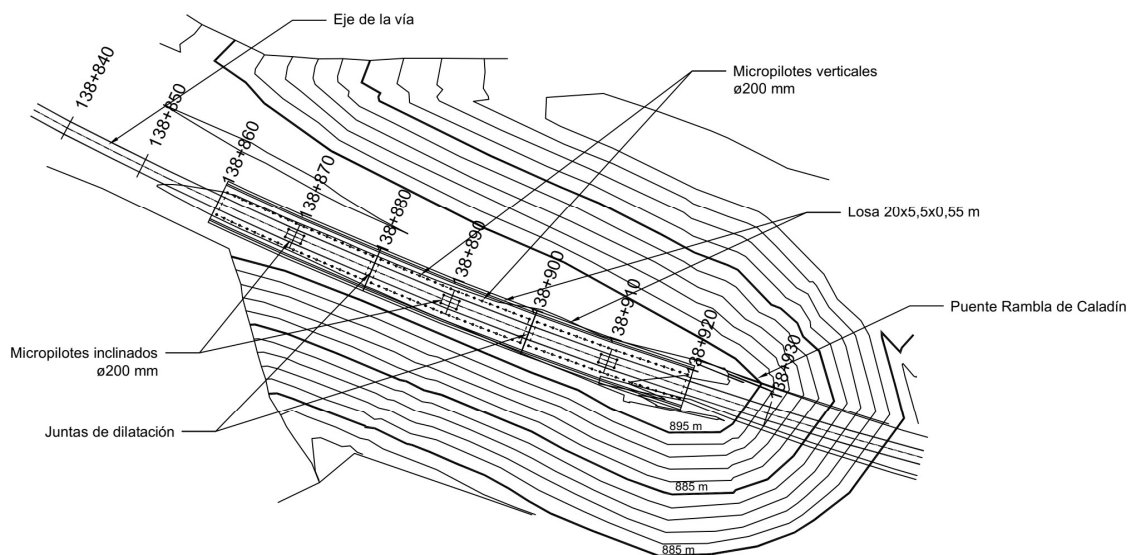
Vista en planta de la Solución A junto con topografía del terraplén
